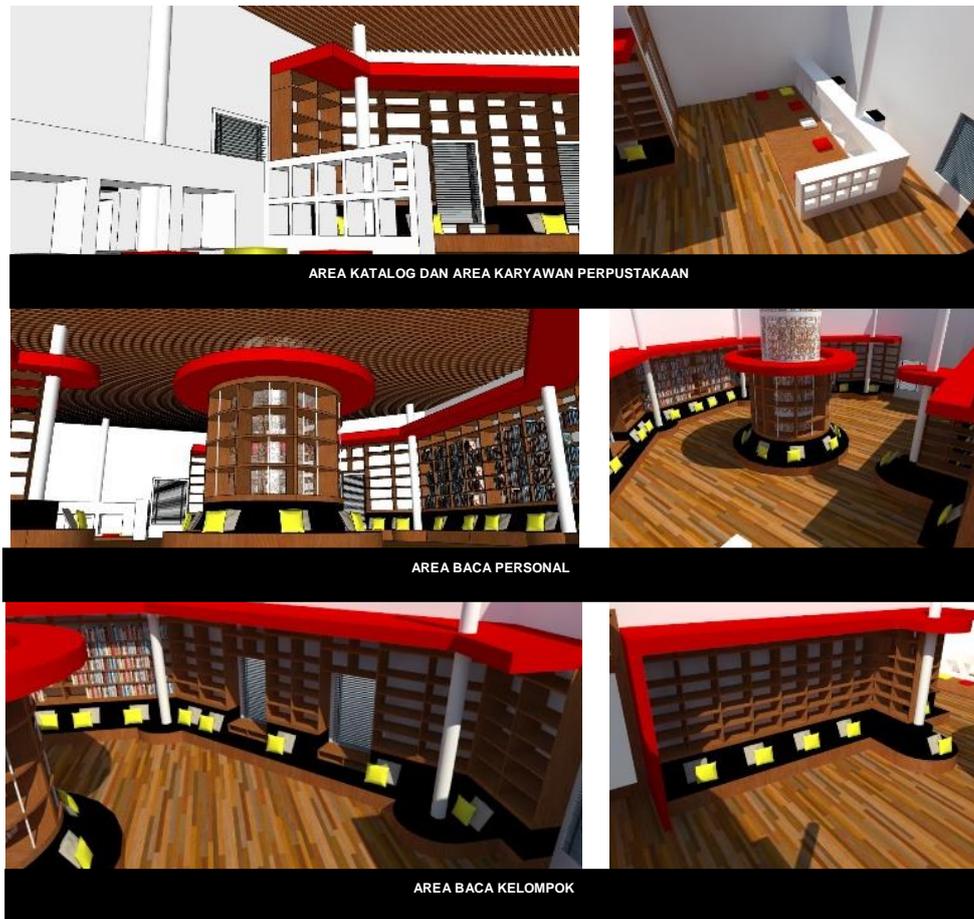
Layout Ruang Baca & Koleksi (Sumber : Peneliti, 2020)
